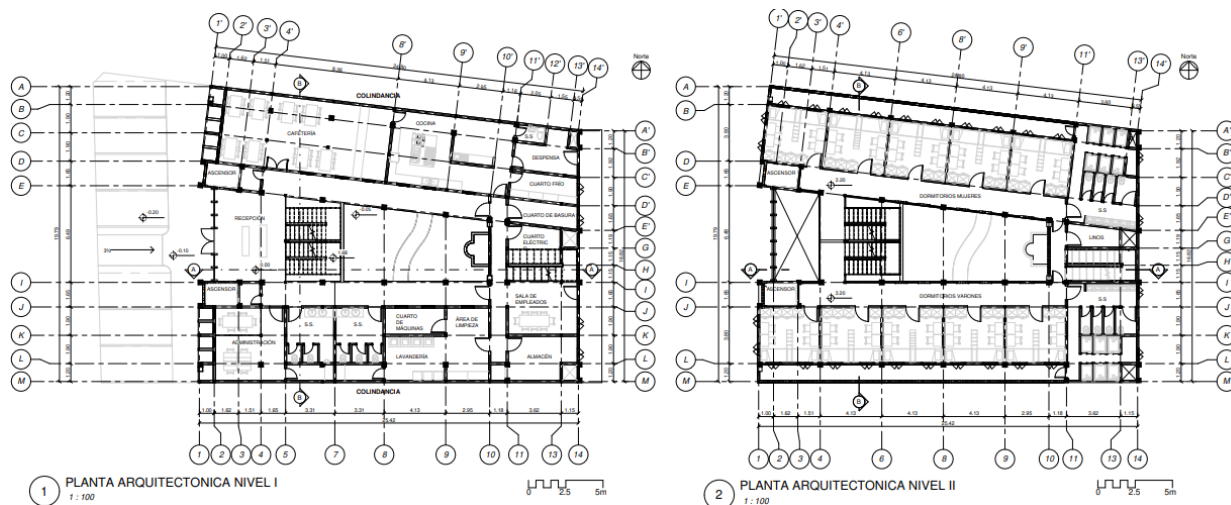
Propuesta Plantas Arquitectónicas Niveles I y II. Fuente: Elaboración propia
